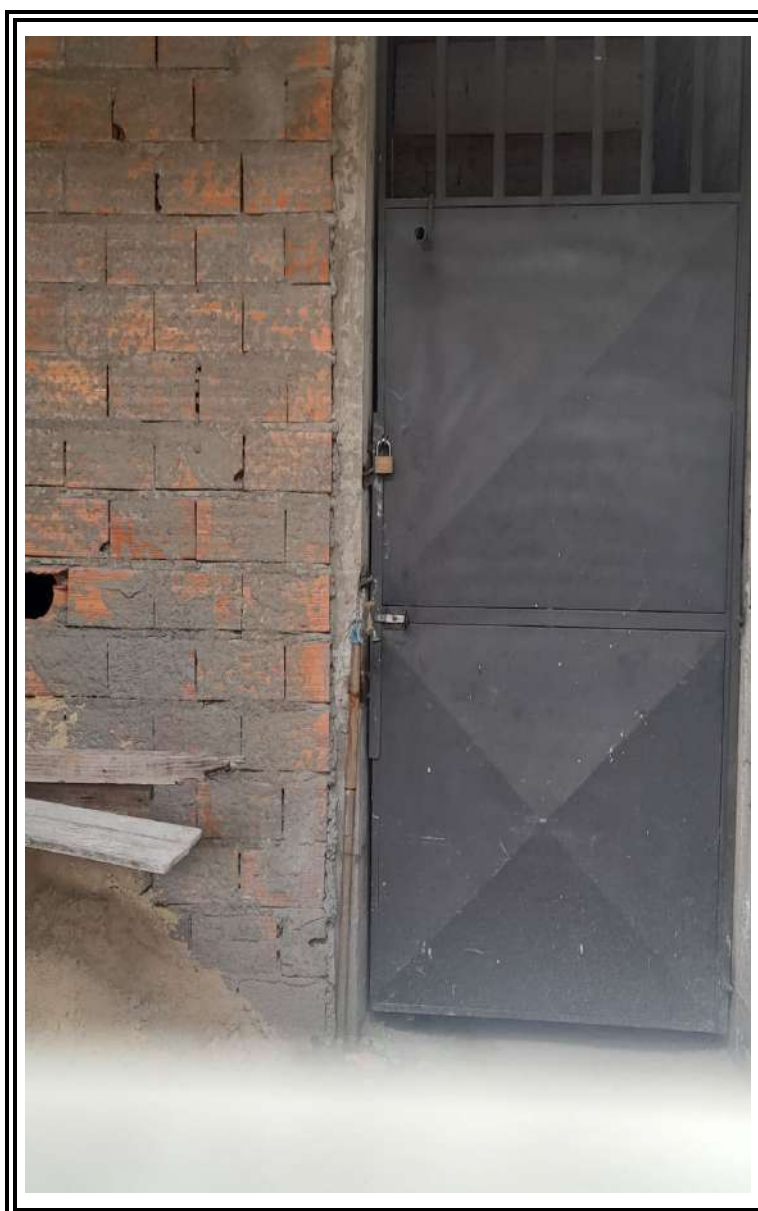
Detalhe da entrada (parte interna) do imóvel
